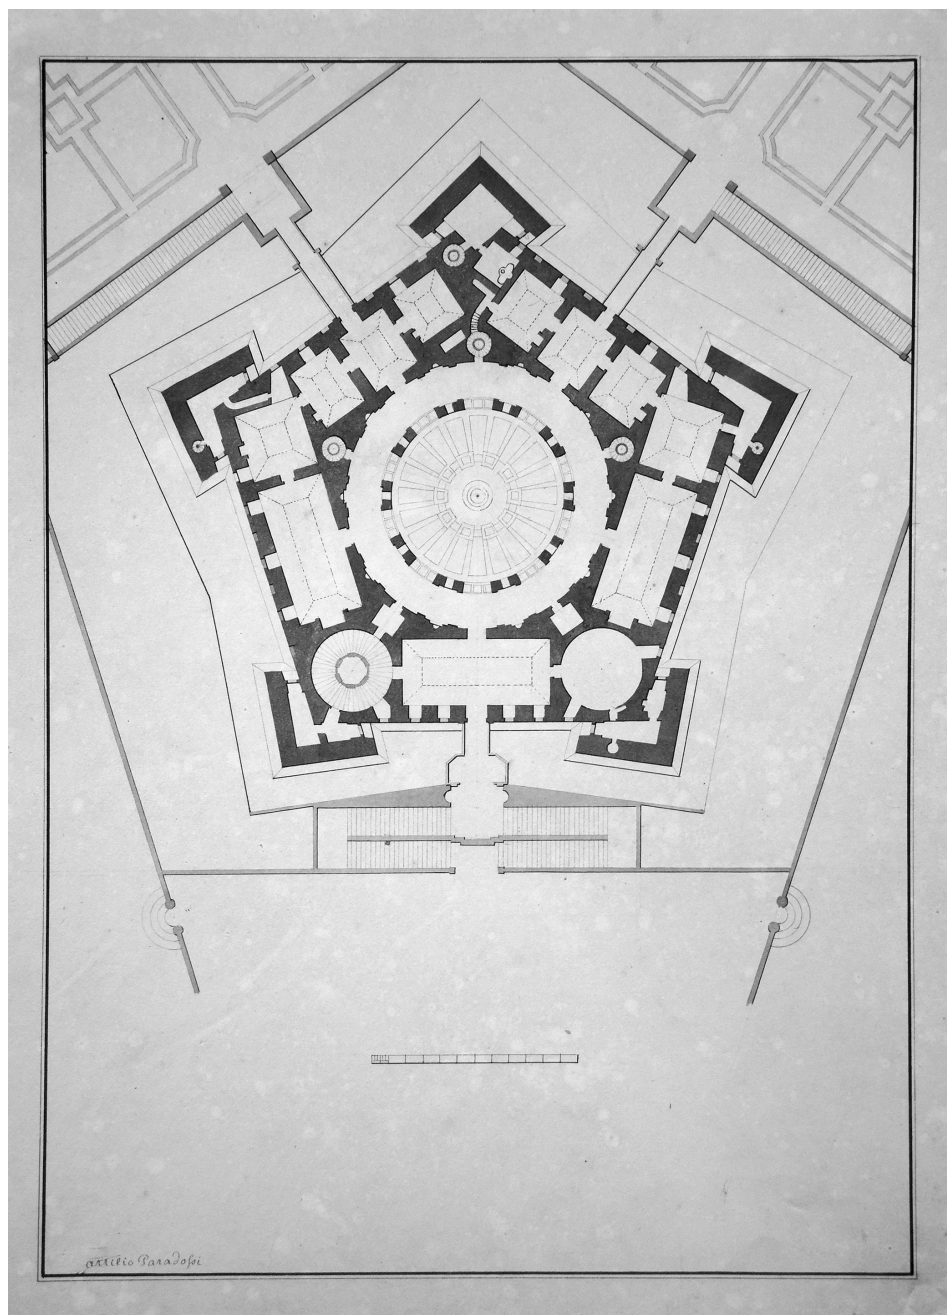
Attilio Paradossi, Pianta del piano terreno della Villa di Caprarola.
